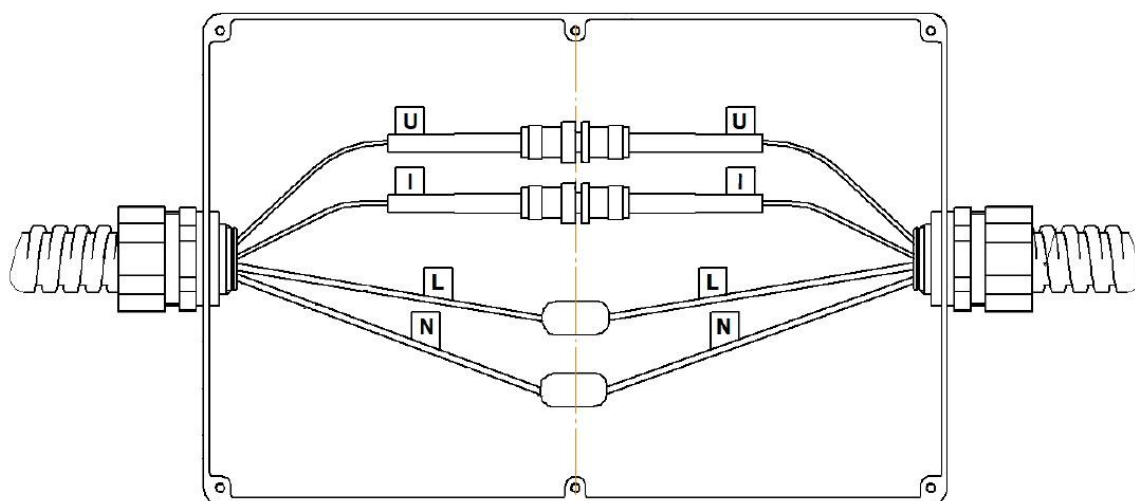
Монтаж соединительной коробки устройств I-TOR-35(110S)-PN.
